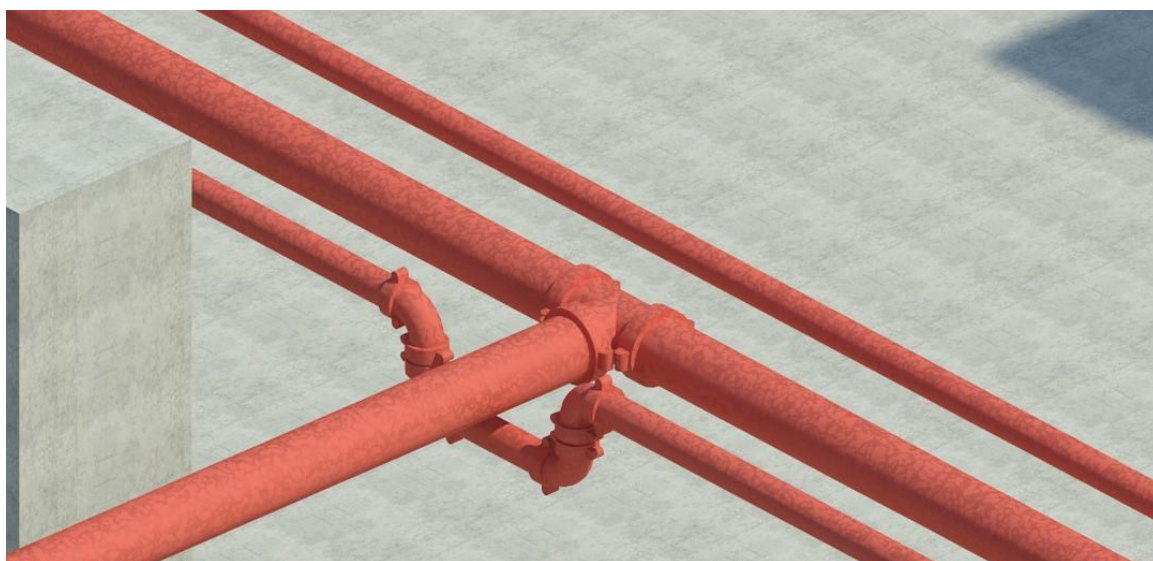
Pormenor do Traçado B (Piso -1)
